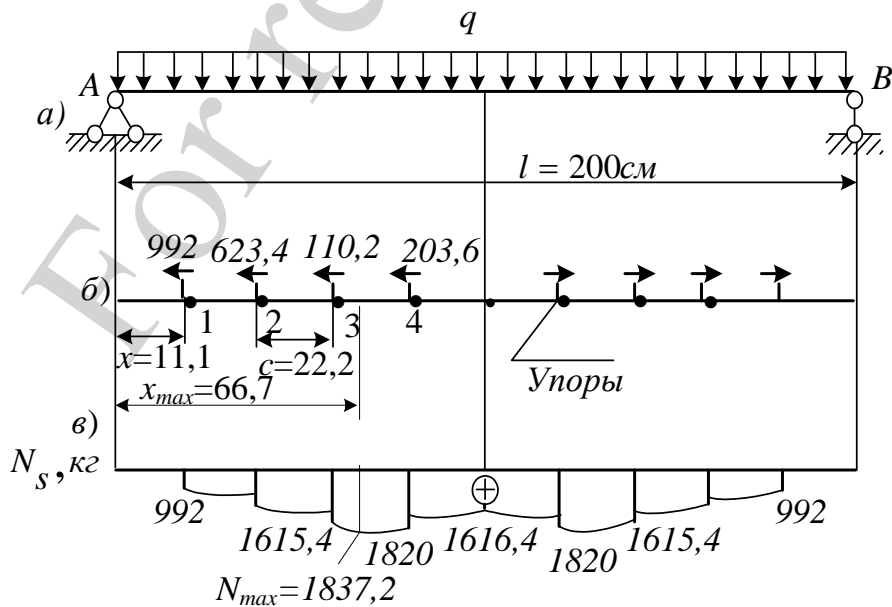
Расстановка упоров и эпюра продольных сил в стальном листе: а – расчетная схема; б – схема расположения жестких упоров; в – эпюра продольных сил
